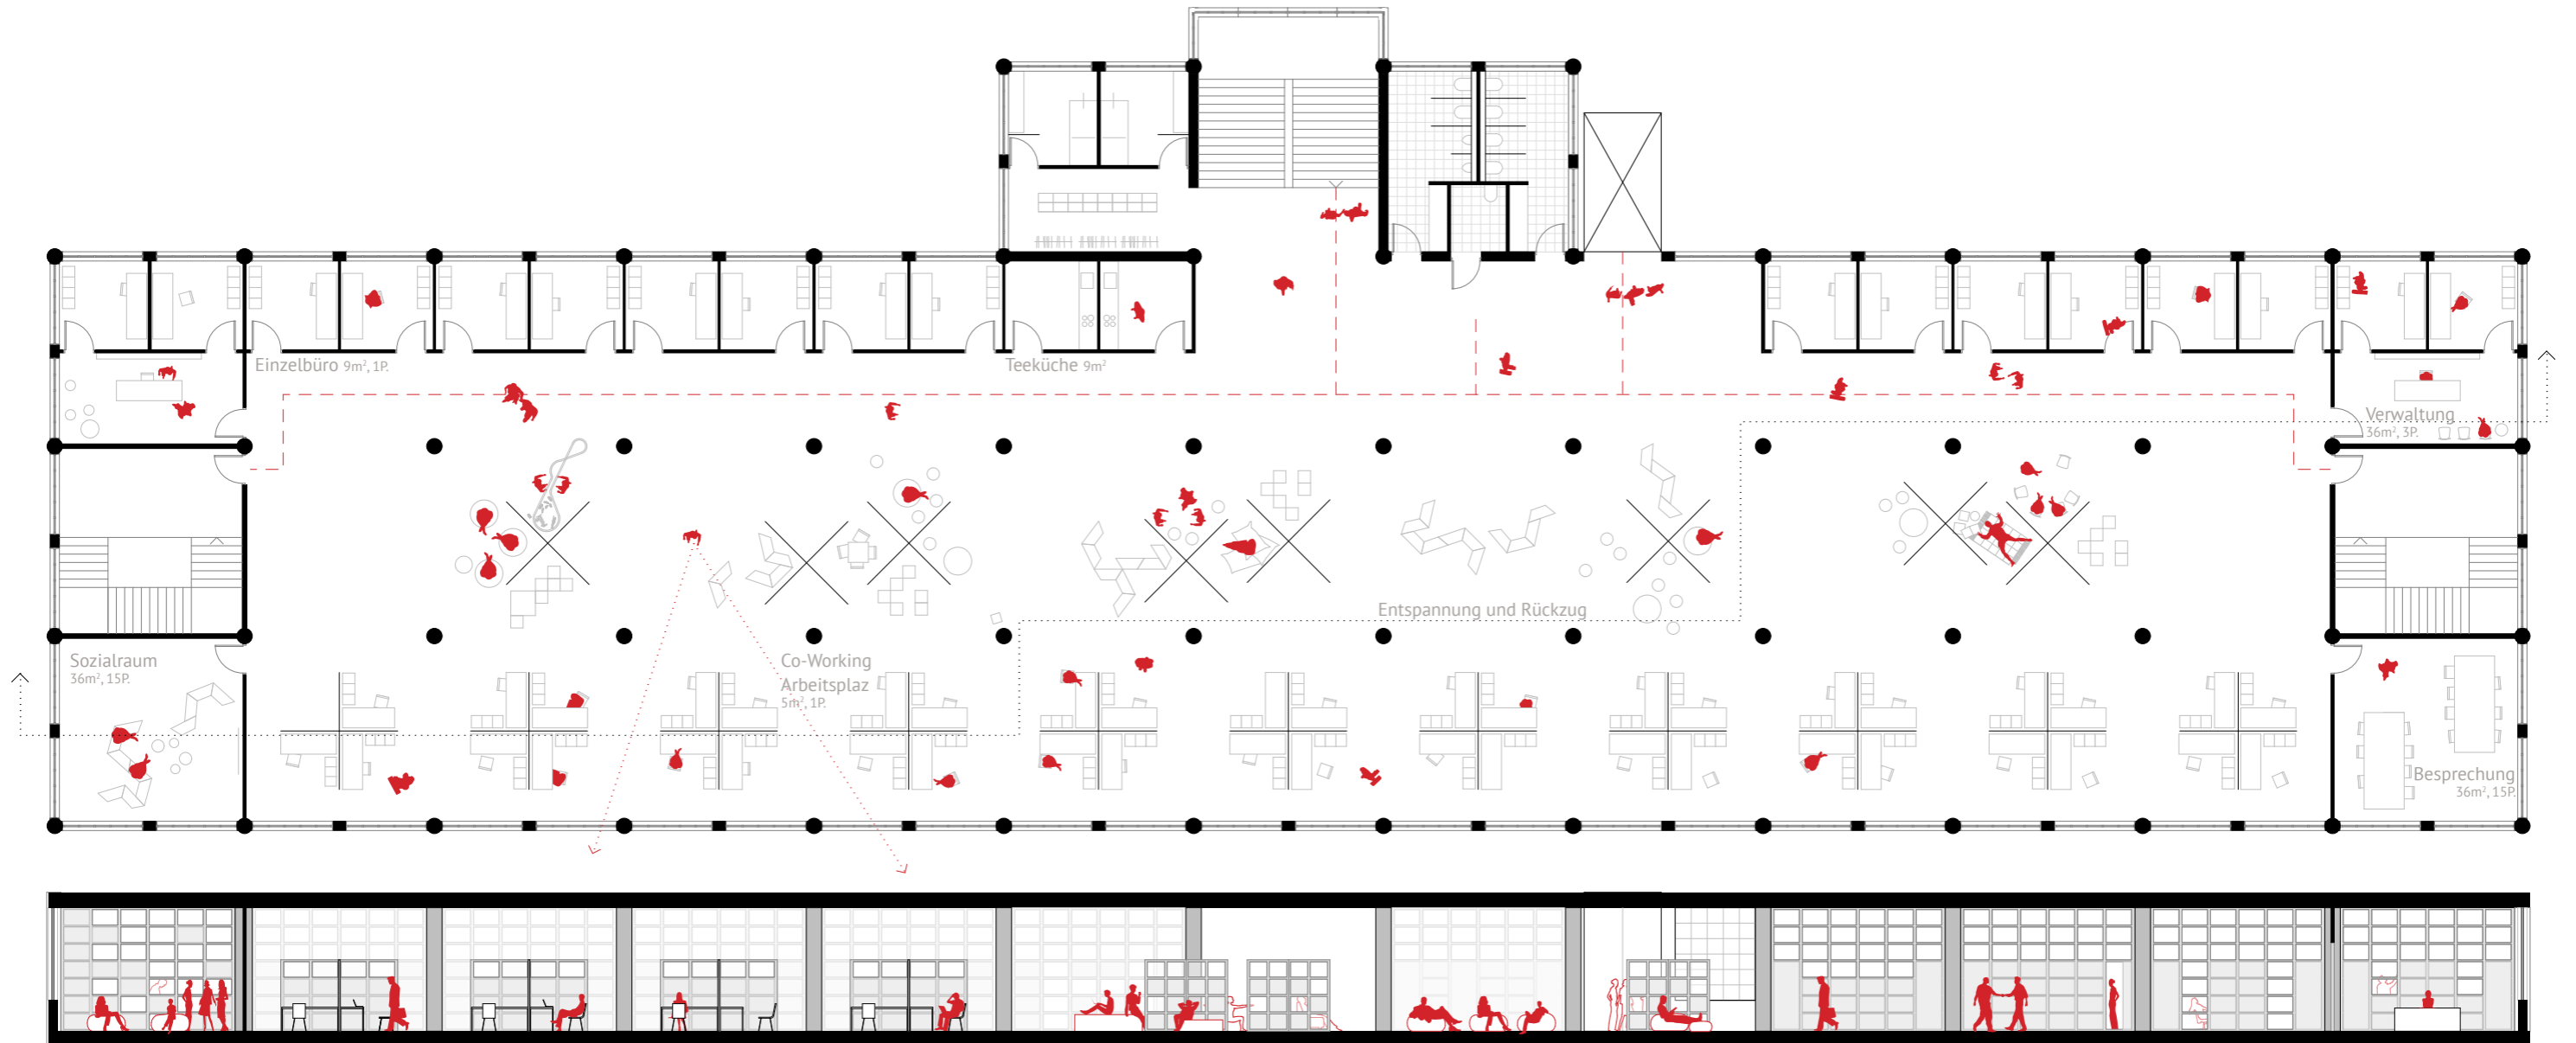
Grundrissvariante mit Räumlichkeiten <10 m²
